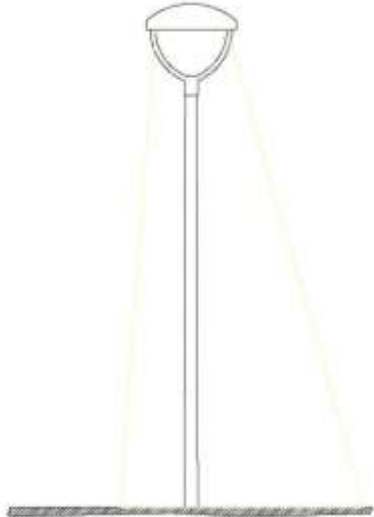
Apparecchi stradali per tipici da 1 a 14 (Tabella 10) - Inclinazione apparecchio nel sistema di fissaggio a montaggio laterale
